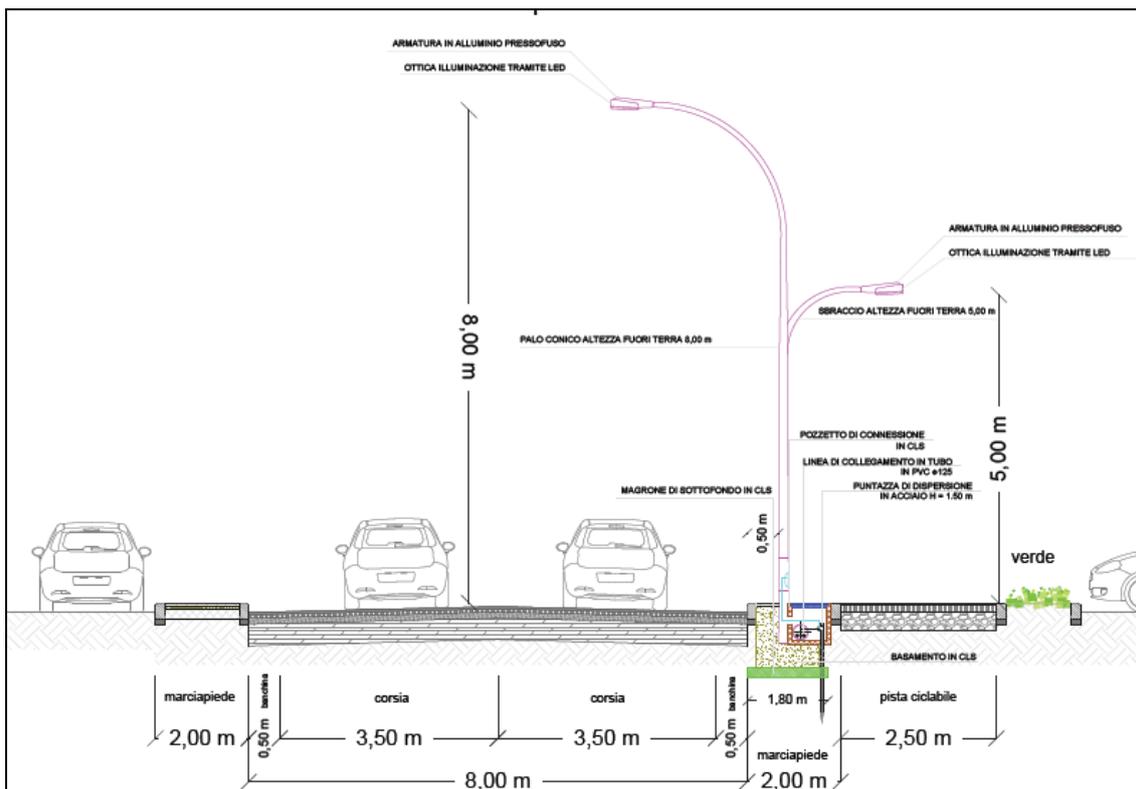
Palo pubblica illuminazione a doppio sbraccio
